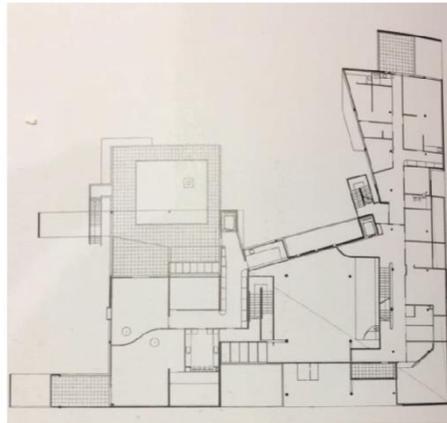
Planta Baja. Torcy. Fuente: libro Henri Ciraiini, 2016
